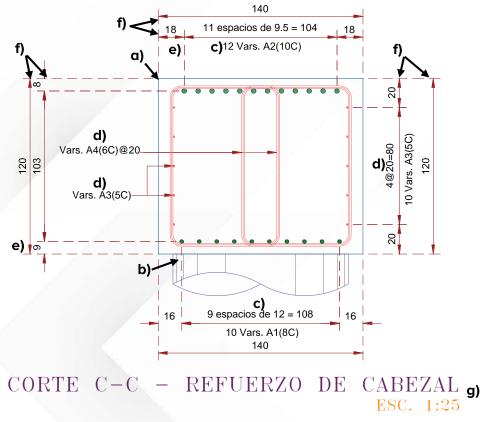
Ejemplo de refuerzo del cabezal de pila, corte C-C
